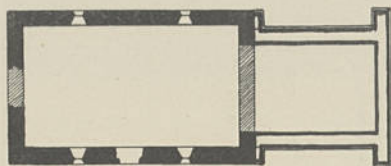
CHAPELLE DE LELLE. (PLAN.)
